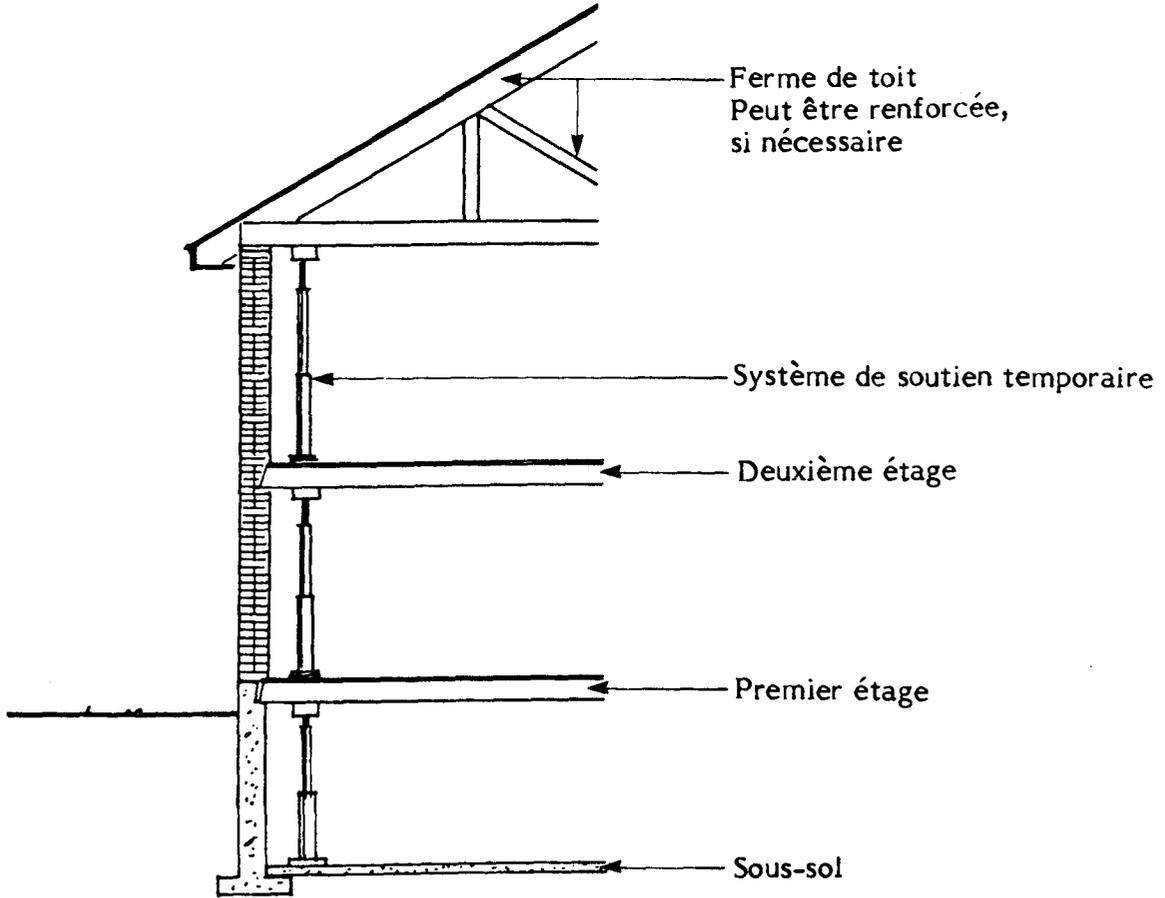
SOUTIEN TEMPORAIRE POUR L'ENLÈVEMENT D'UN MUR
